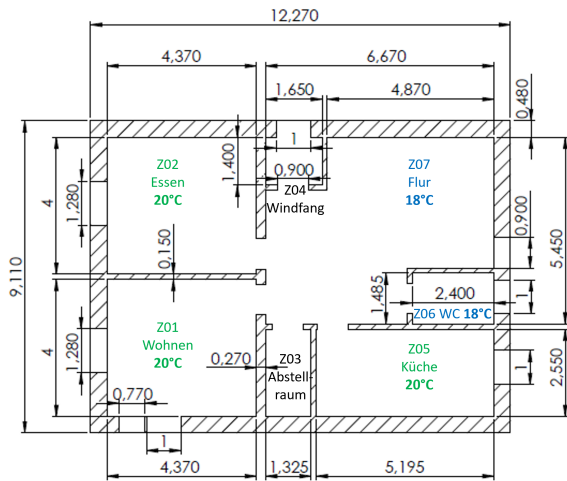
Grundriss: Erdgeschoss
